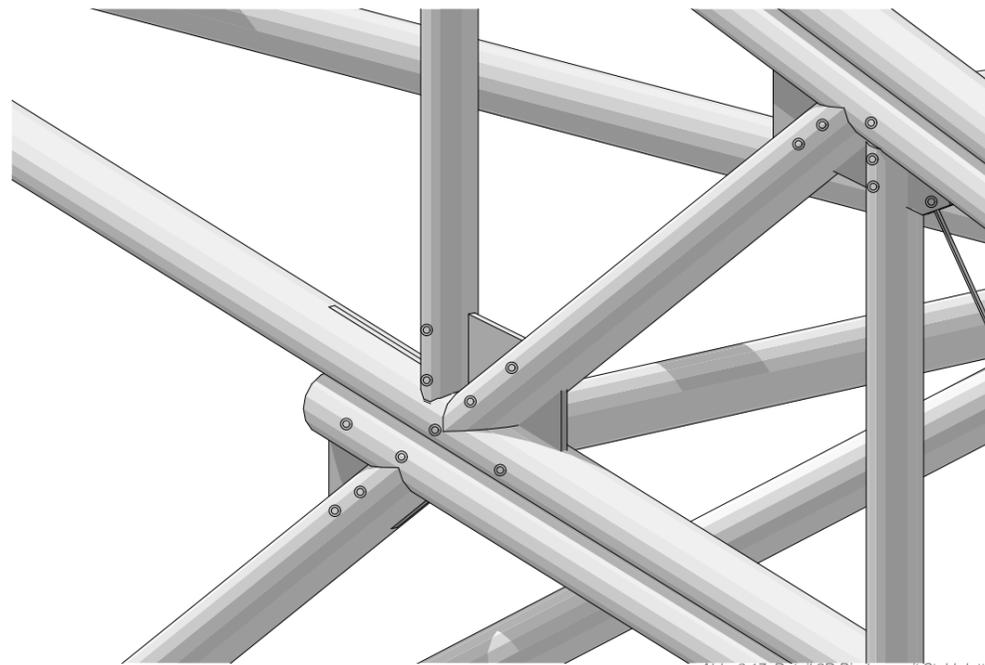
Detail 3D Bindung mit Stahlplatte
